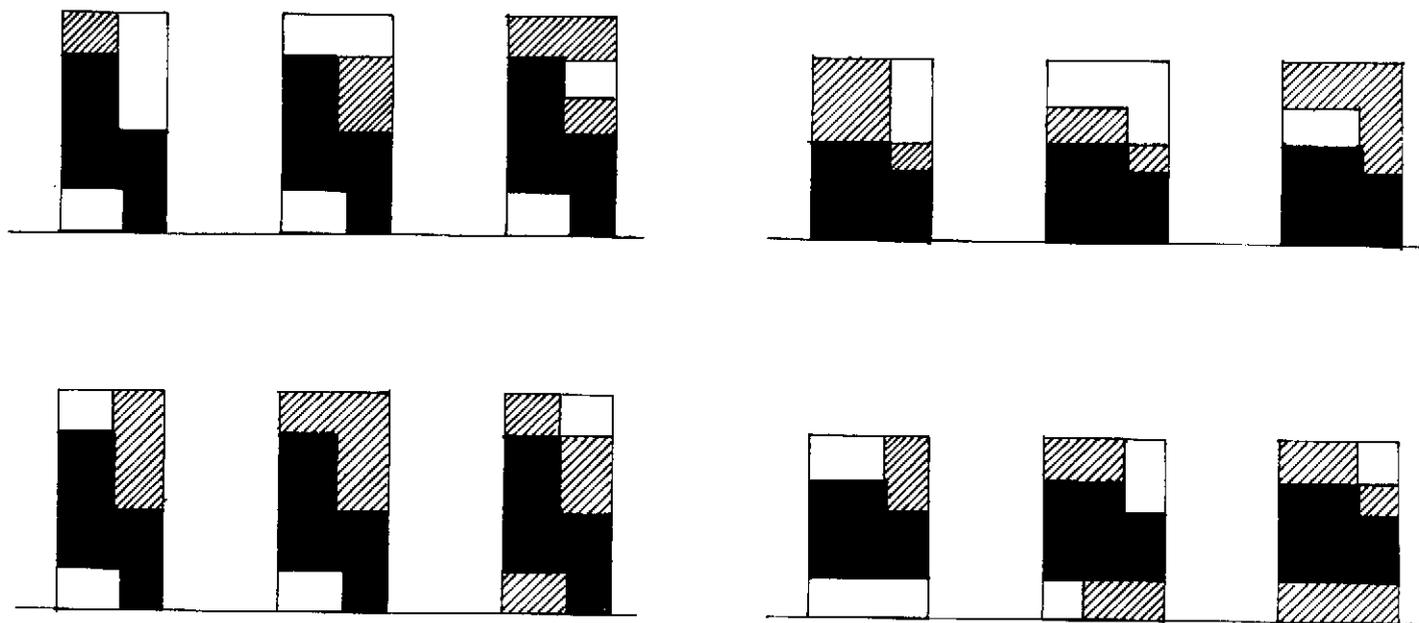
Detalle de emplazamientos de las viviendas típicas en la colonia Primero de Julio.
